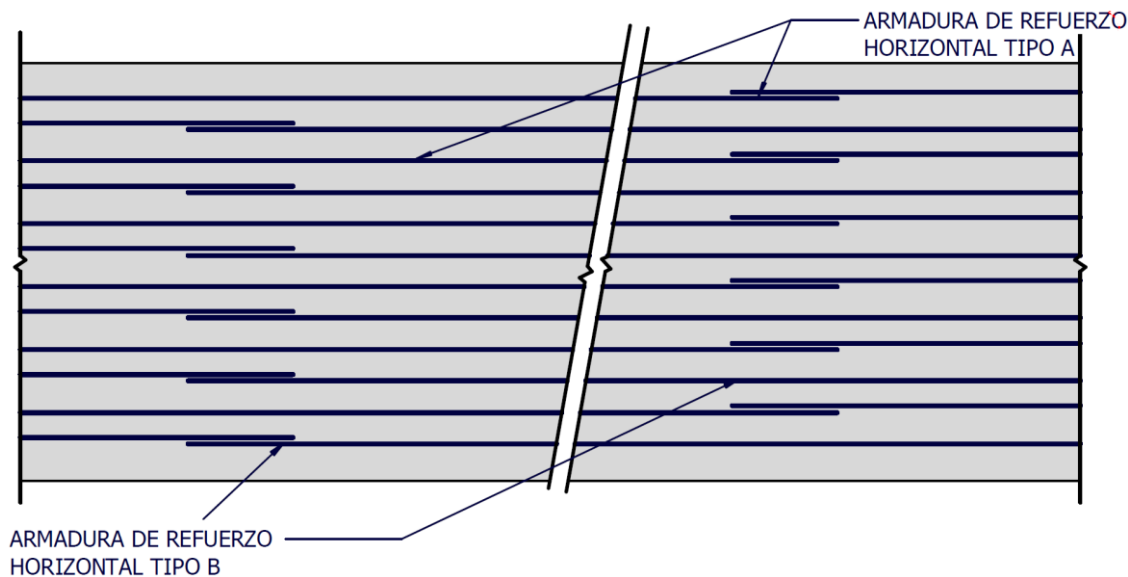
Detalle de alternancia de reforzamiento por traslape a tensión
